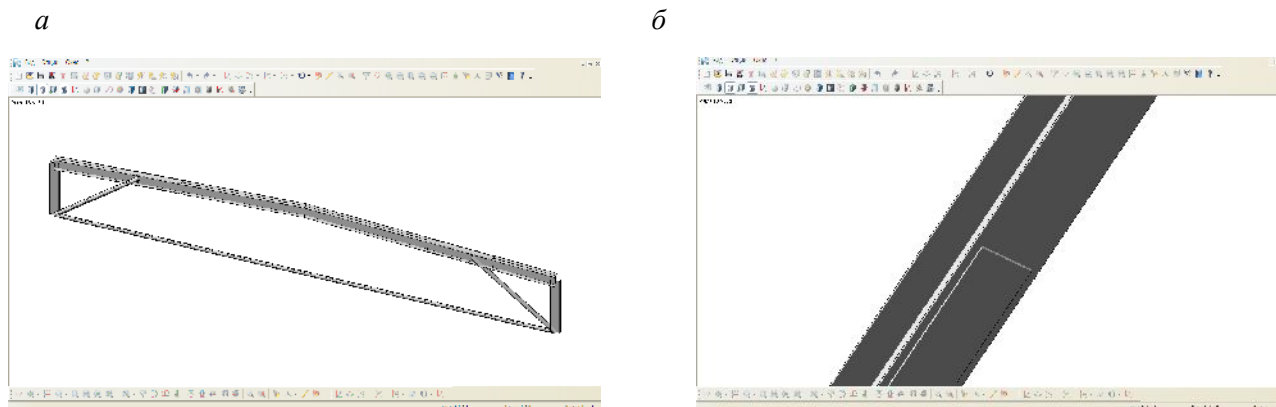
КЭ модель конструкции покрытия для расчёта в ПК ЛИРА САПР; общий вид (а); усиление пояса, фрагмент (б)
